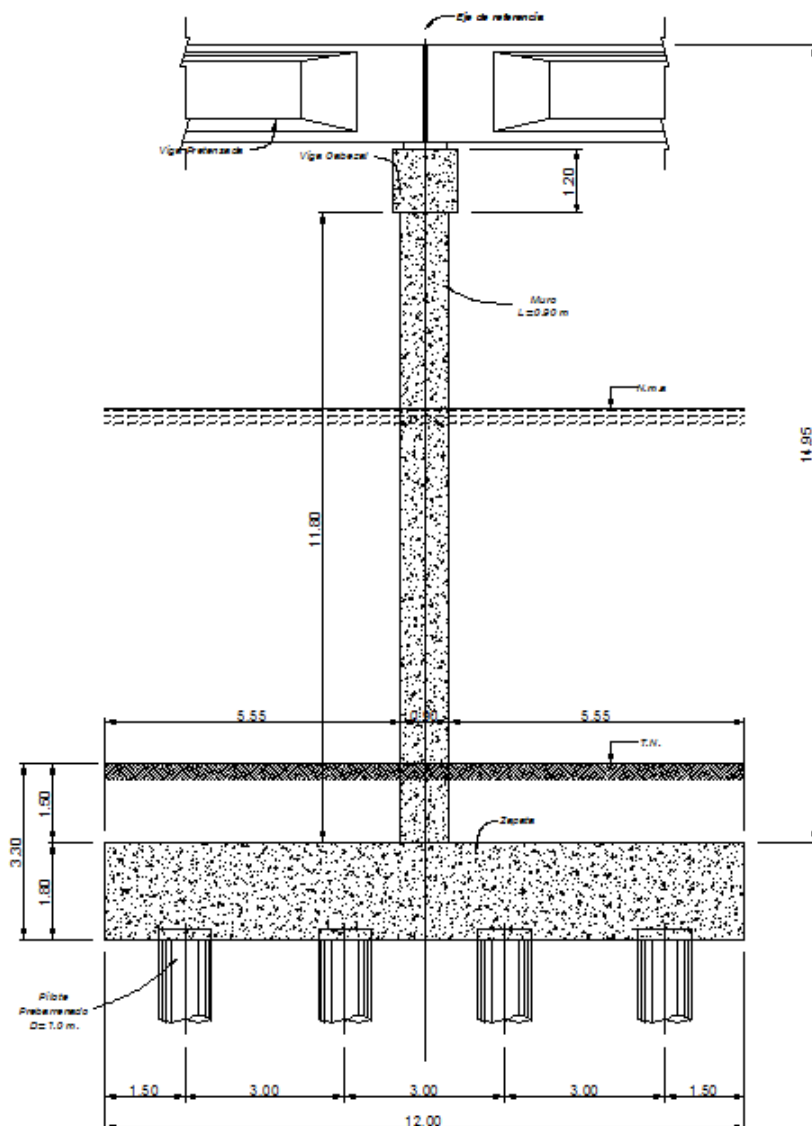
Vista lateral de la pila P3 con pilotes.
